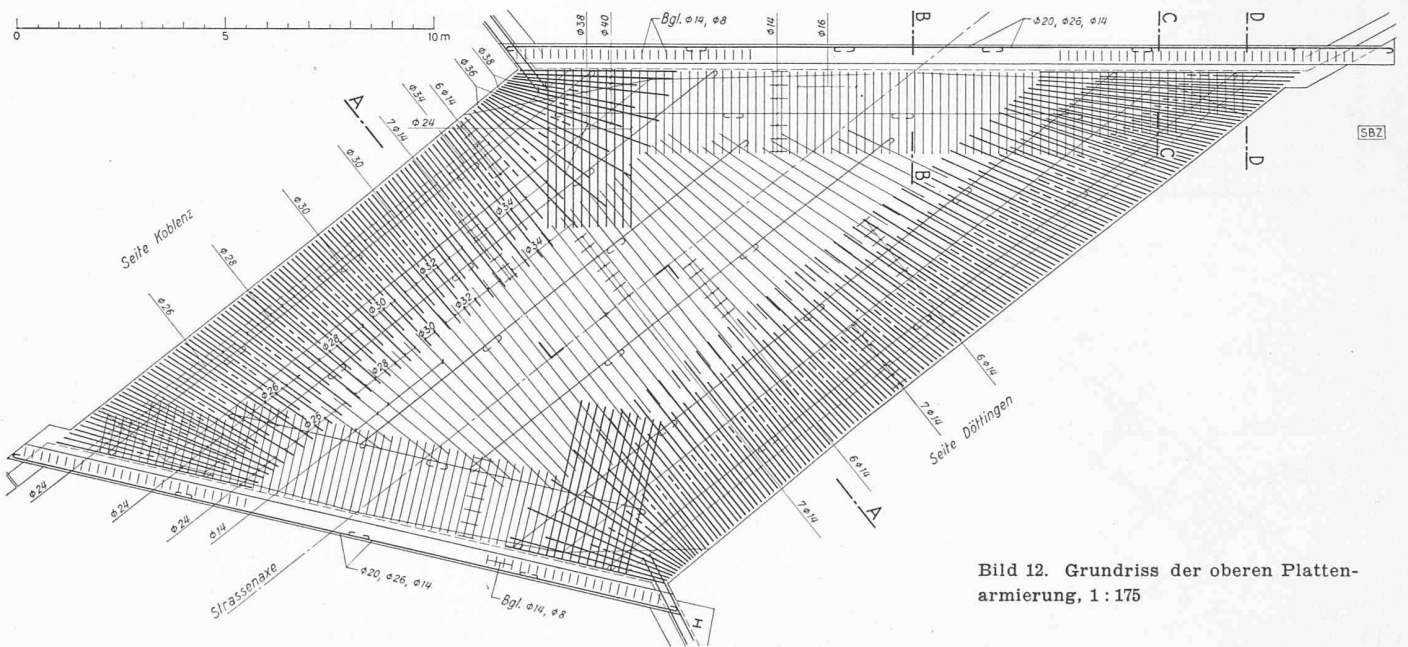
Grundriss der oberen Plattenarmierung, 1 : 175
